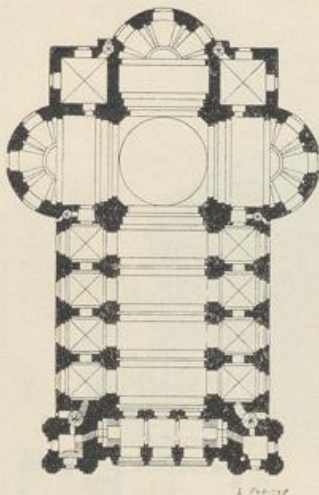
Grundriss des Doms zu Salzburg
